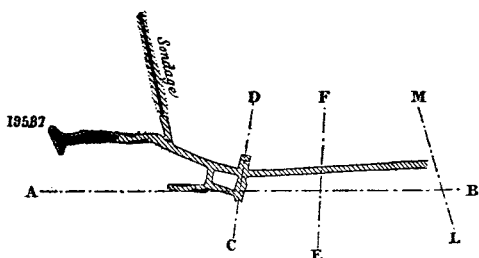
Mine Nygrufva (Ammeberg). — Plan au niveau de 200 mètres.
